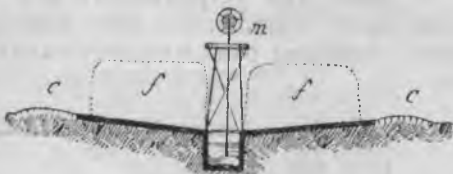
Поперечный разрёзъ выпуклой площадки.
